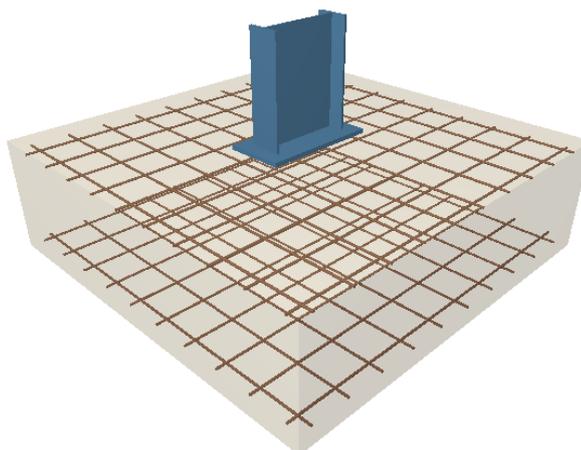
Zapata Z1. Fuente: CYPE 2017
